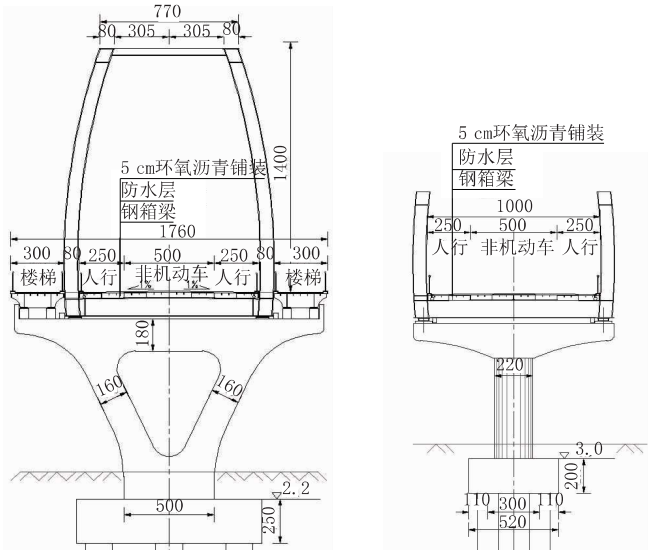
苏州新叶桥桥梁横断面剖面图(单位:mm)
